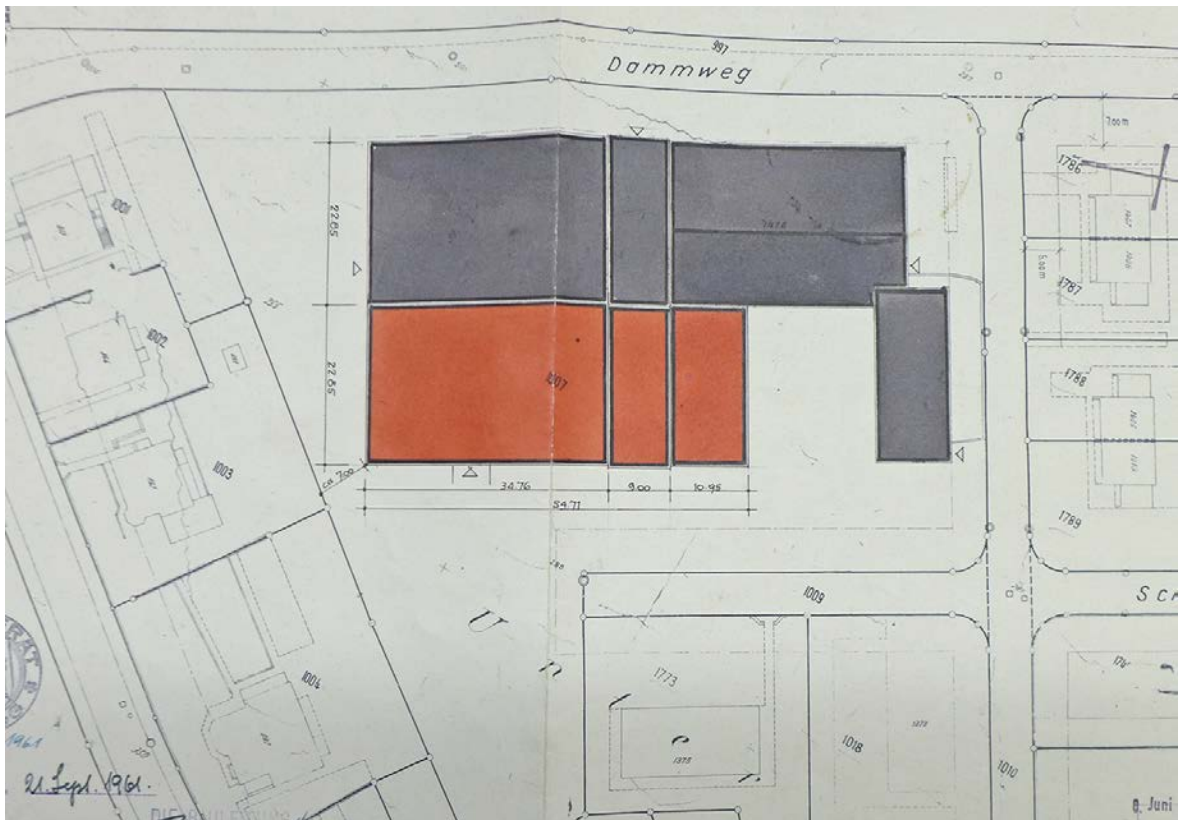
Katasterplan dritte Bauetappe: Erweiterung Produktionshalle. (Baugesuchsarchiv Dossier 3097)
